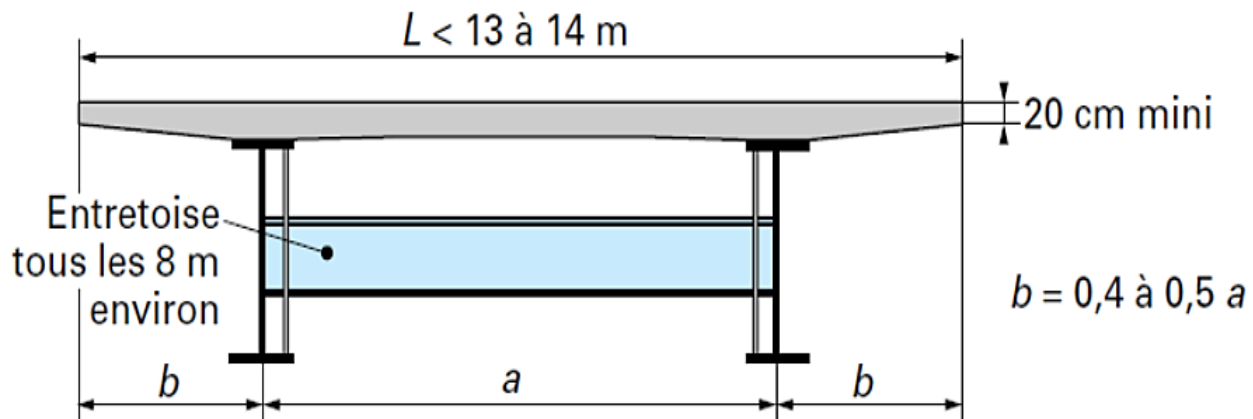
Schéma d'un bipoutre à entretoise.
